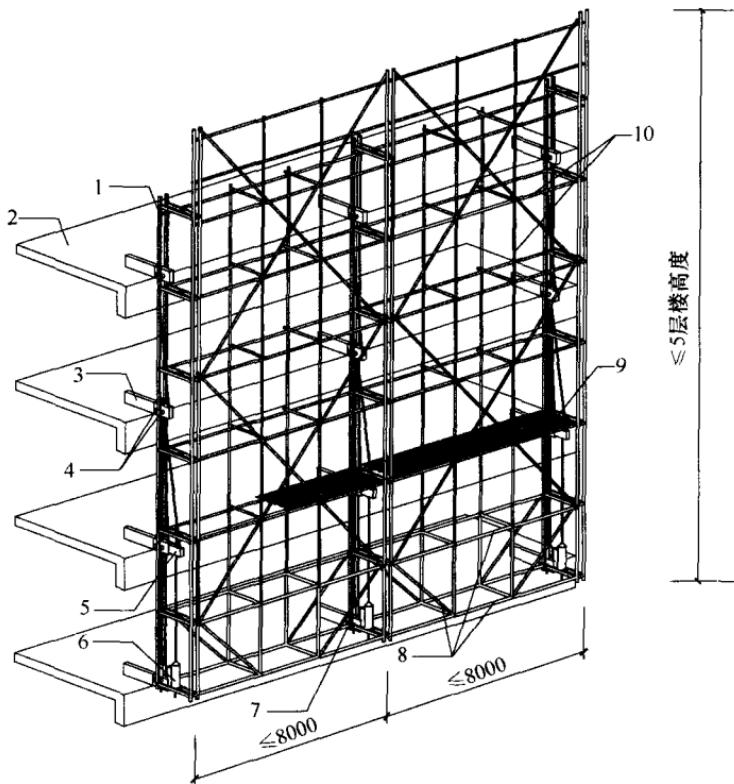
液压升降整体脚手架总装配示意图（单位：mm）
